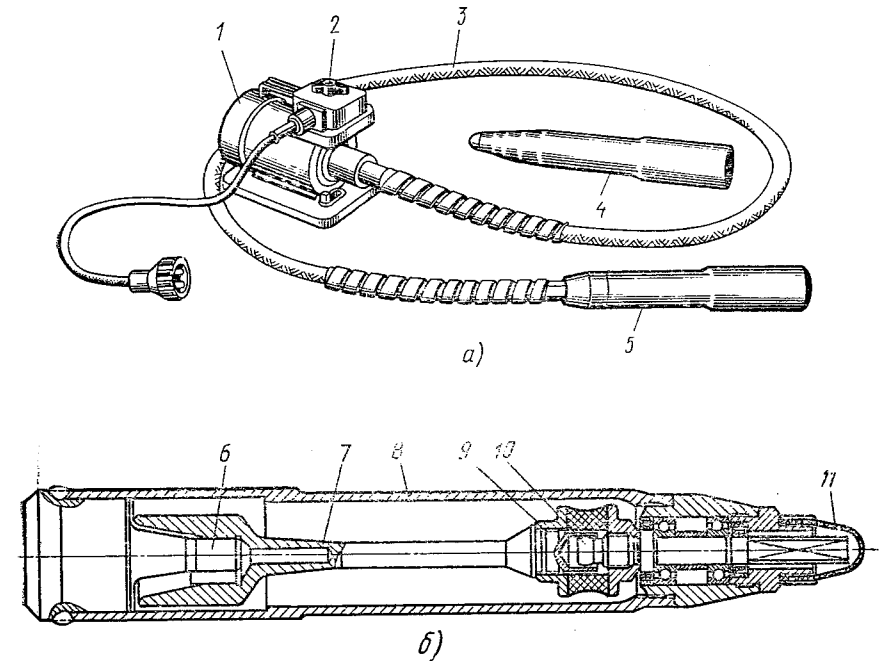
Глубинный вибратор с гибким валом ИВ-47Б:
